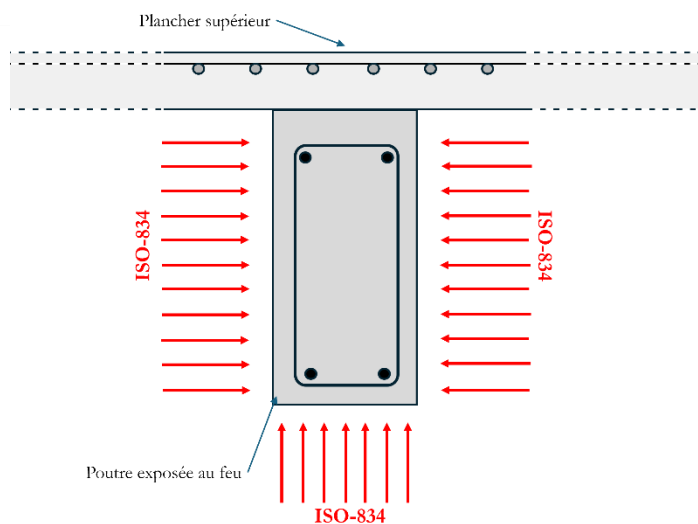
Schéma d'une coupe transversale d'un élément poutre en béton armé exposé à un flux thermique issu d'une évolution de température ISO-834
